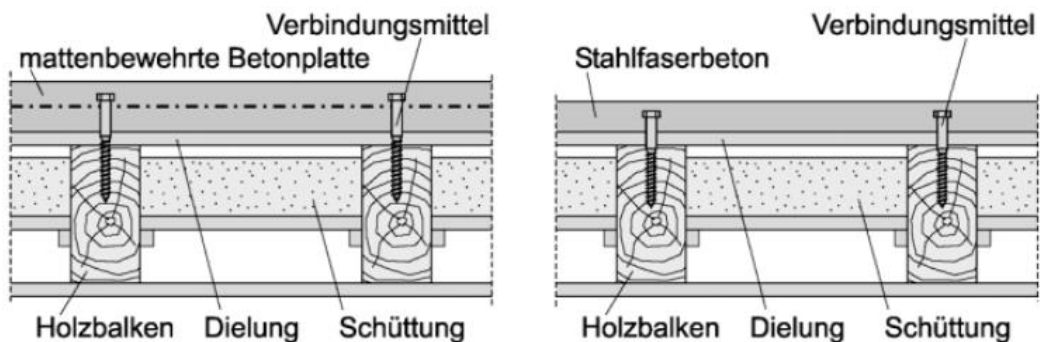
Wegfall der Betondeckung bei Anwendung von Stahlfaserbeton [22]
